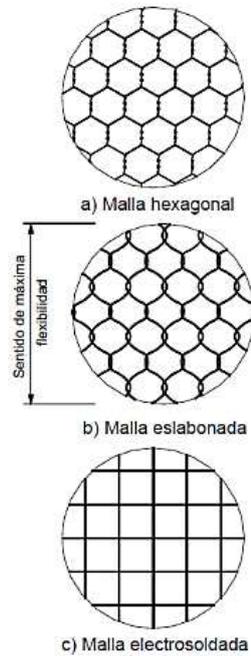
Tipos de mallas utilizadas en la construcción de gaviones. Fuente: (Suárez Díaz, 2001).
